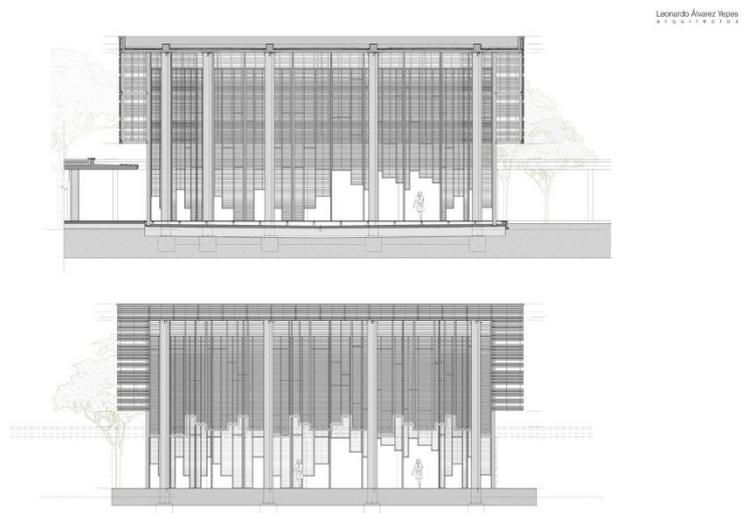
Vista de corte del edificio comercial la Plaza Ciudad
